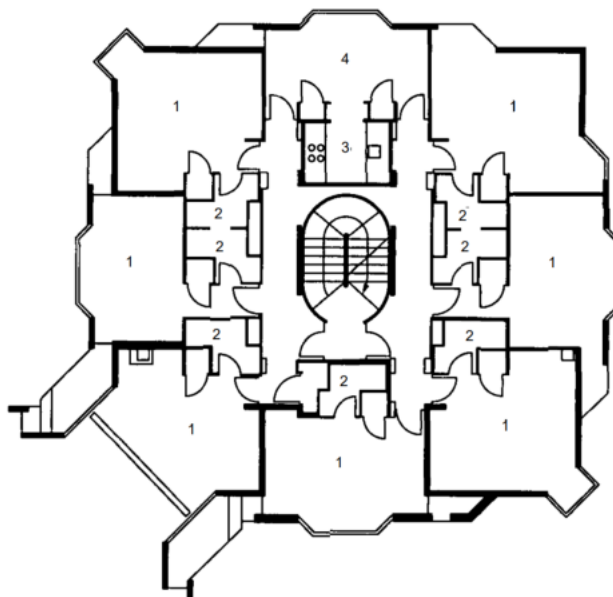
Planta do Pavimento Tipo. Balliol College, Reino Unido
